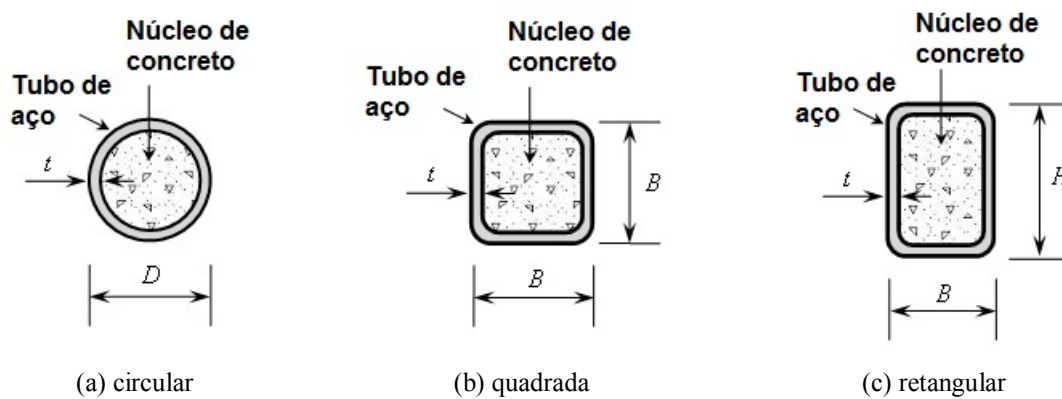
Perfis de aço tubulares preenchidos com concreto: seções transversais típicas
